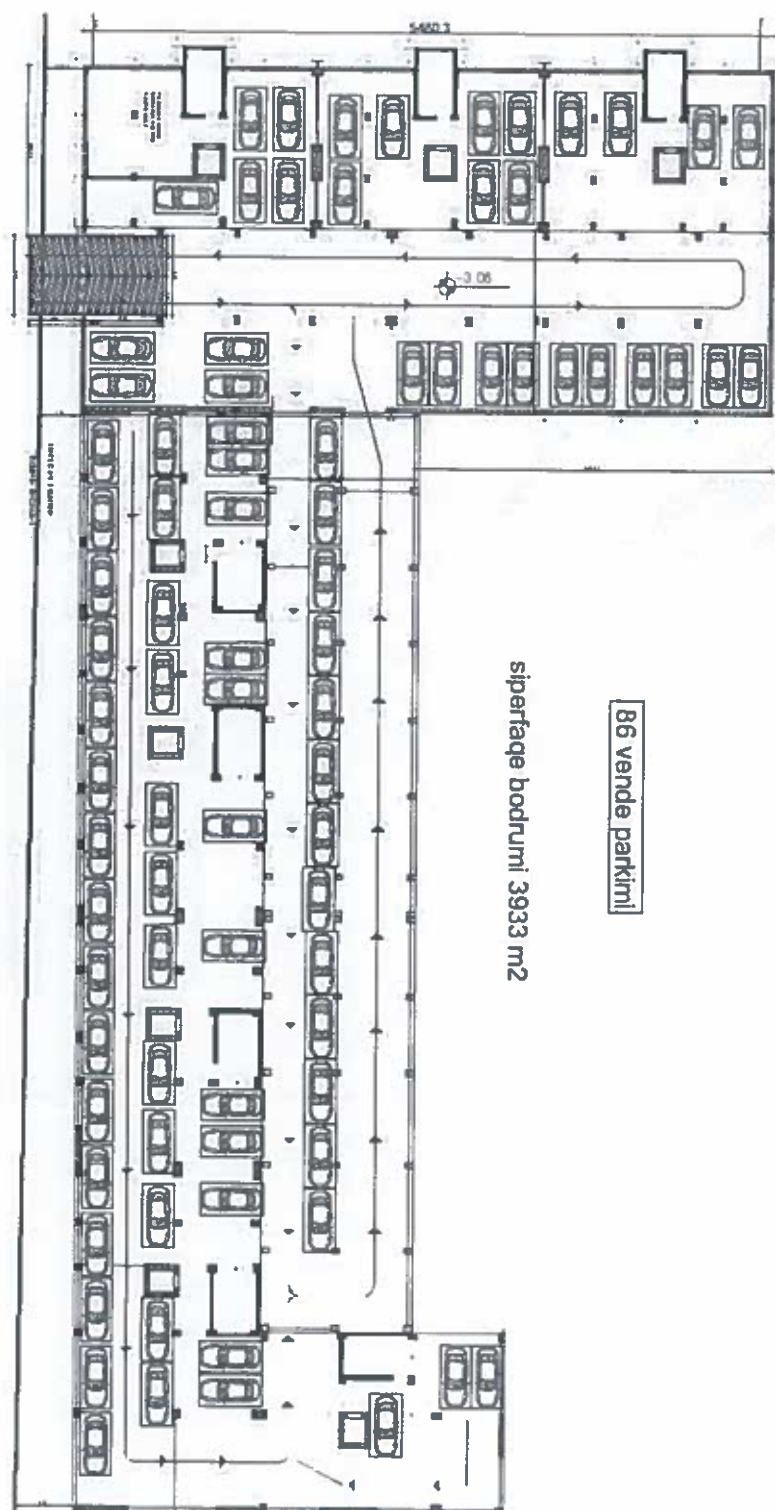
Planimetria e katit -I – Objekti 2.2 dhe 2.3
